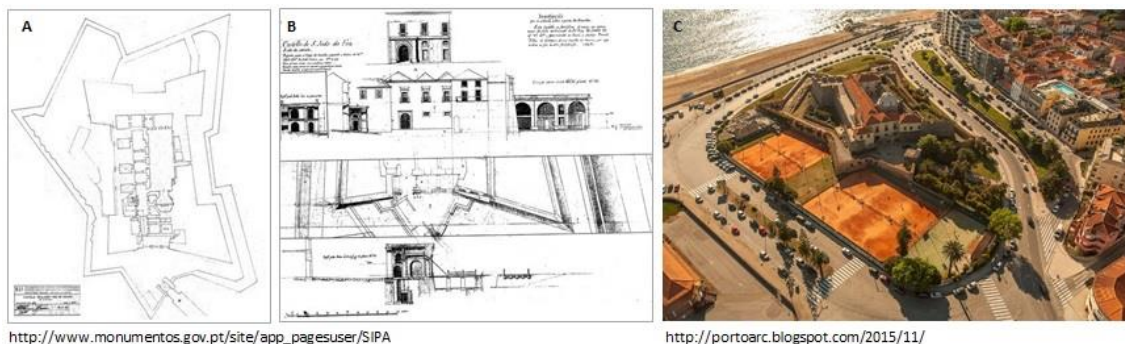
Forte de São João da Foz A. Planta do Forte; B. Alçado do projeto de arquitetura. C. Vista aérea do Forte.
